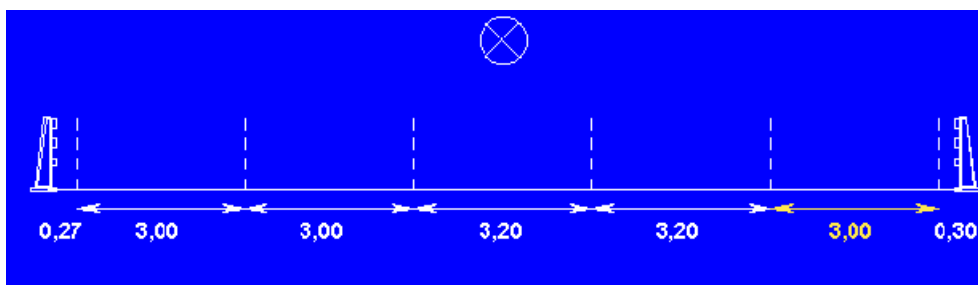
Profils en travers du site au droit de l'ouvrage du RER A, après aménagement
